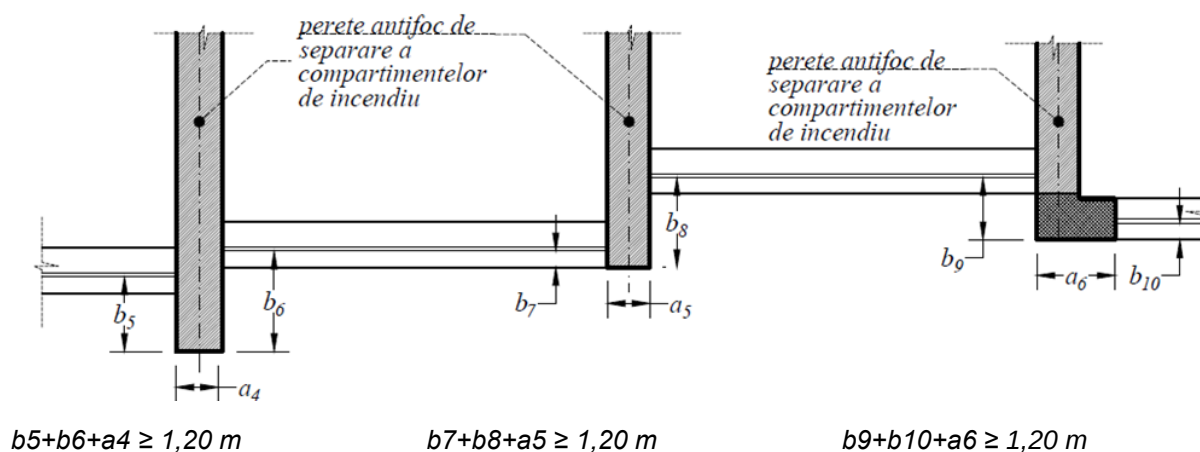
Стены противопожарного отсека - горизонтальное сечение
